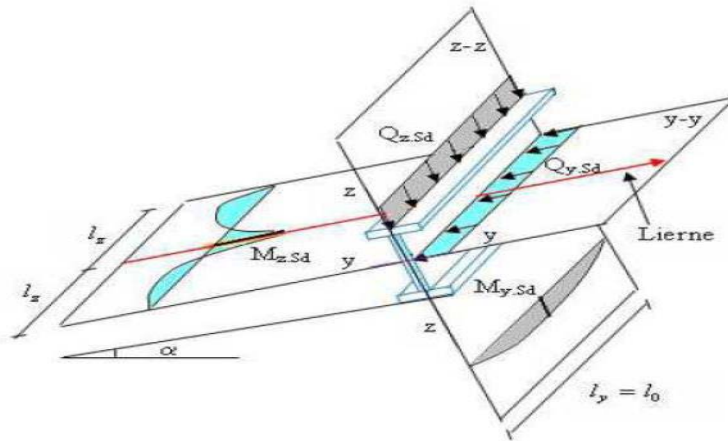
Panne de toiture en flexion sous les différents plans de chargement.
